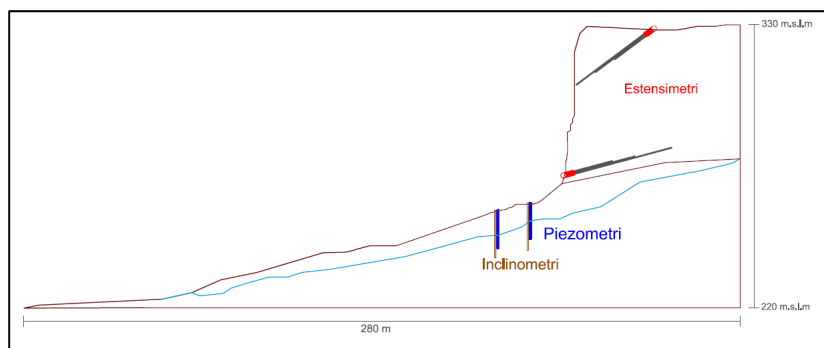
Orvieto: Strumentazione Geotecnica – Schema sezione tipo
